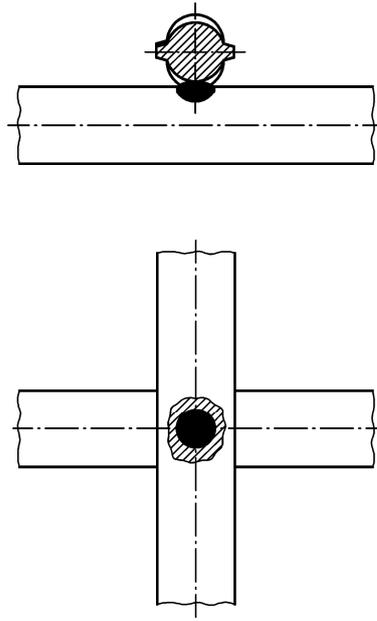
Assemblage en croix soudé par les procédés 21 et 23
